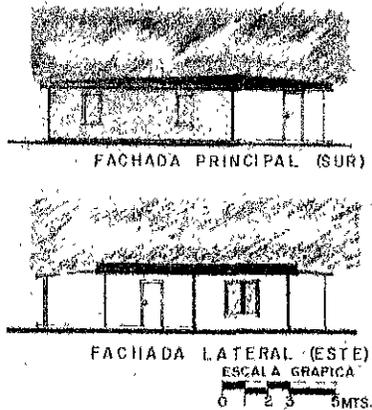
Fachada Sur (principal) y fachada Este, caso 5
